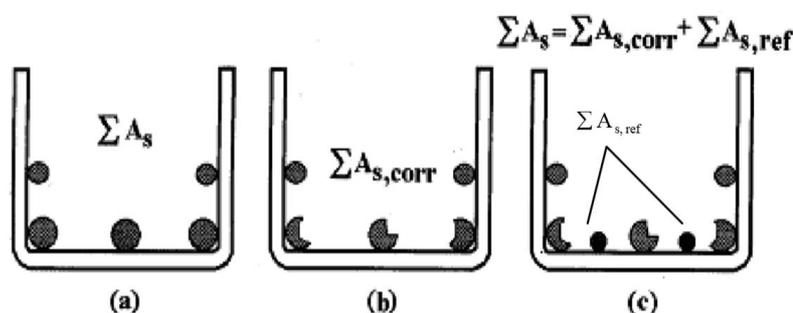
Detalhe da adição de novas barras para complementação da seção de armadura perdida em uma viga. (Souza e Ripper, 1998)
